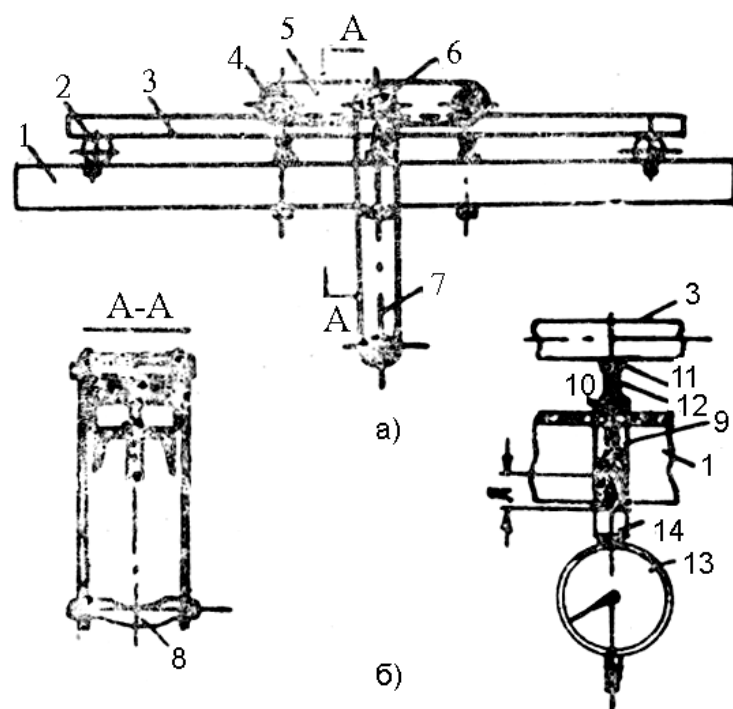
Схема установки для испытания бетона на ползучесть при зигибе
